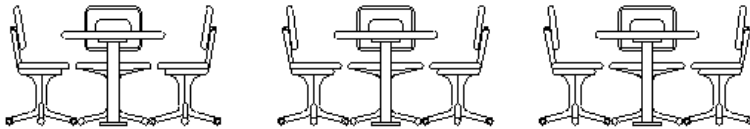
Área entre mesa y mesa de una cafetería vista en alzado.
